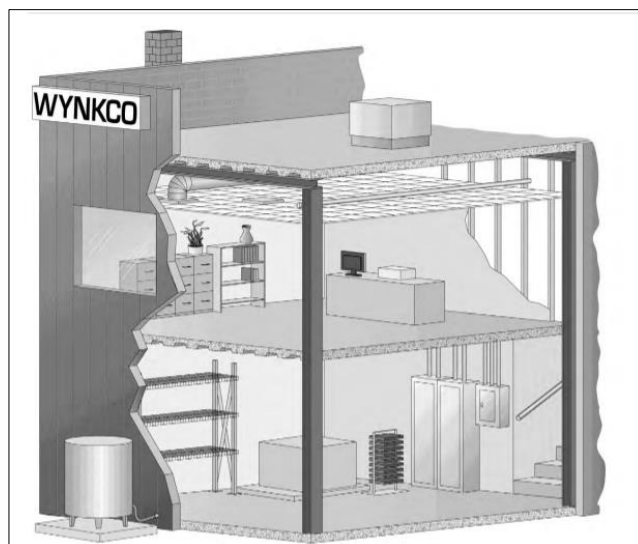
Vista de un edificio con componentes estructurales y no estructurales. Fuente: (Agencia Federal para el Manejo de Emergencias, 2012)
